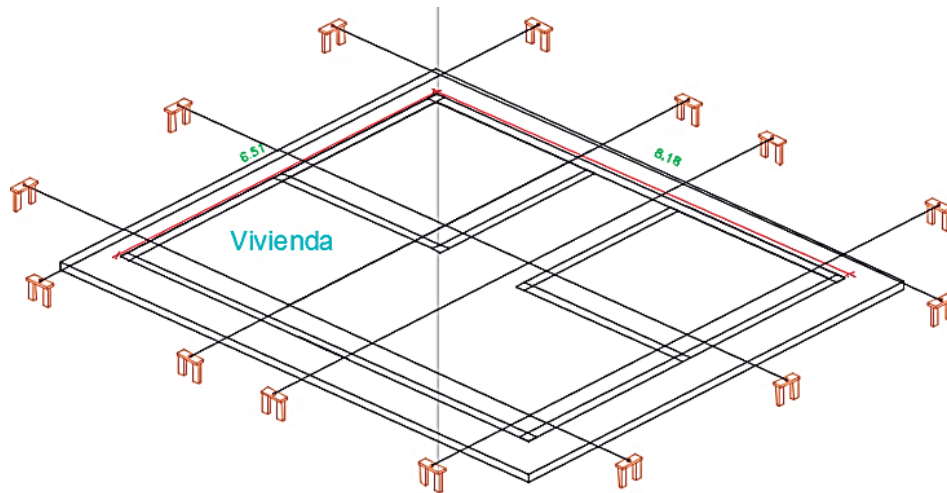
Replanteo de vivienda un área de 53.25m². - AutoCAD, 2018
